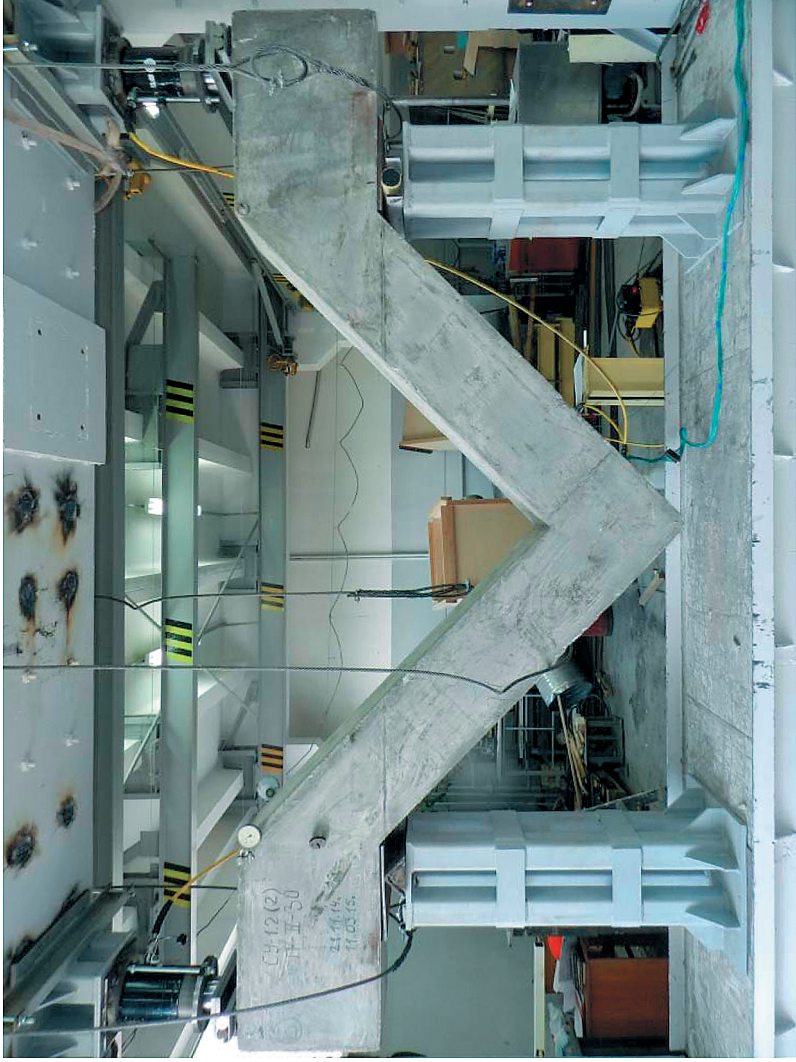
Железобетонная модель углового типа СУ-1.2 (2) в испытательном стенде
